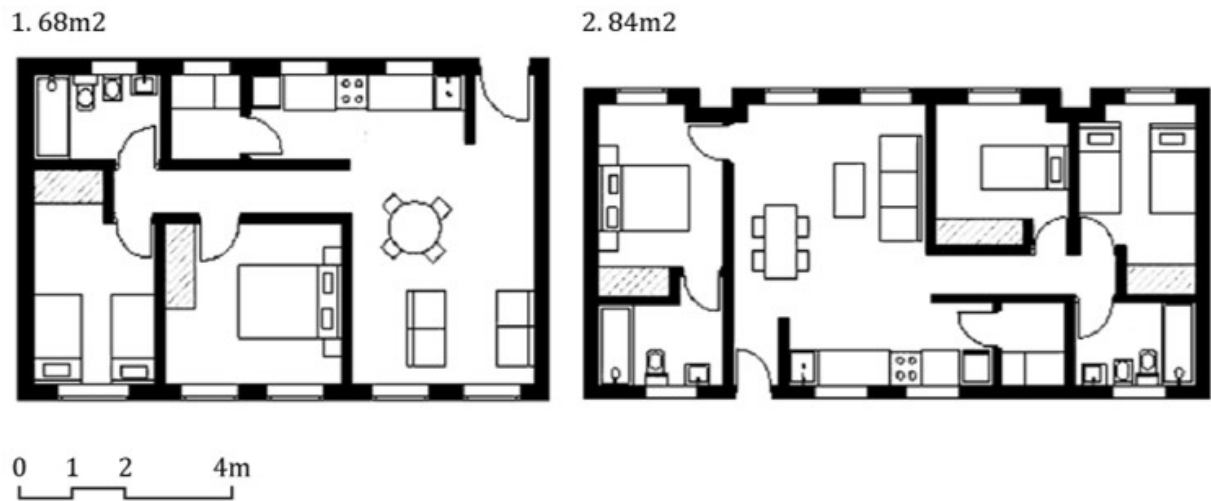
Plantas tipo Vivienda Social Barajas
